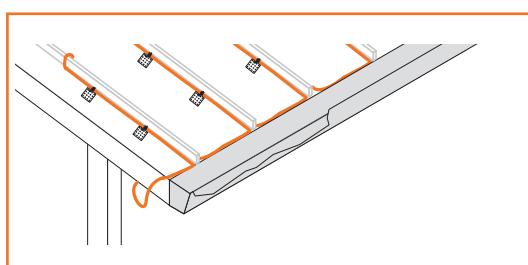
Укладка резистивного кабеля CEILHIT на фальцевой кровле
